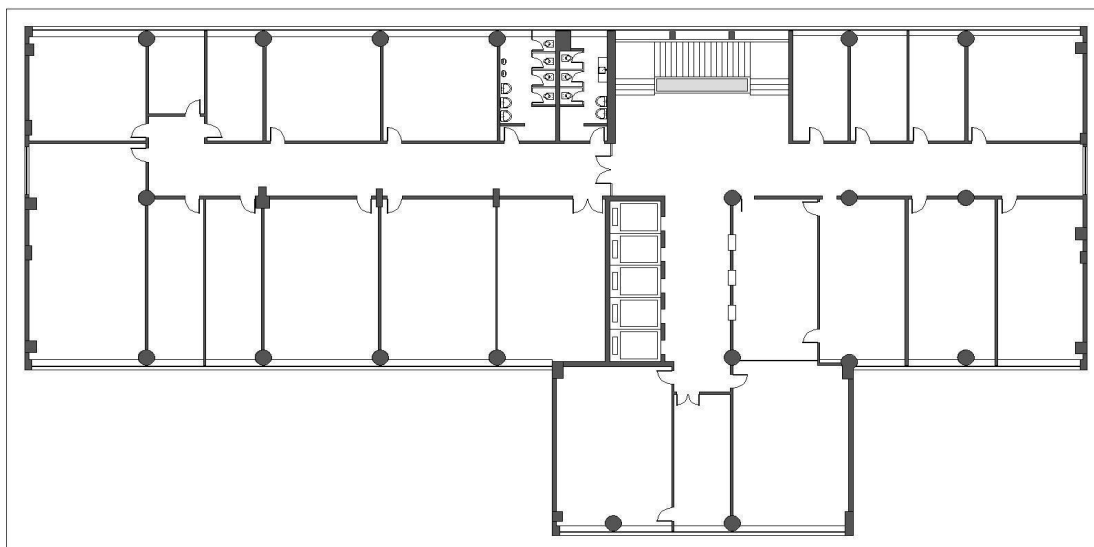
Planta do imóvel - Pavimento tipo - Ed. Álvaro da Silveira
